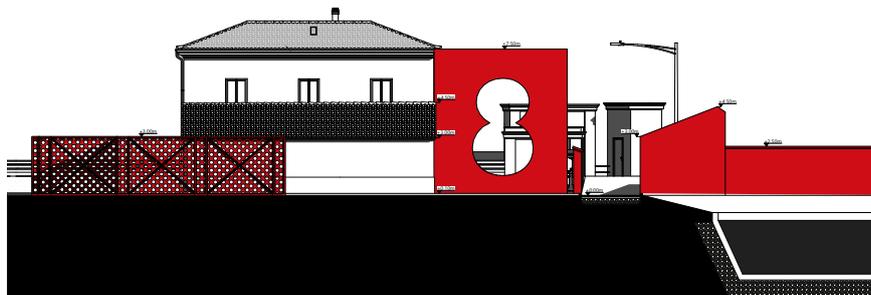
Prospetto sud di progetto. Estratto della tavola 07_Prospetti e sezioni.
